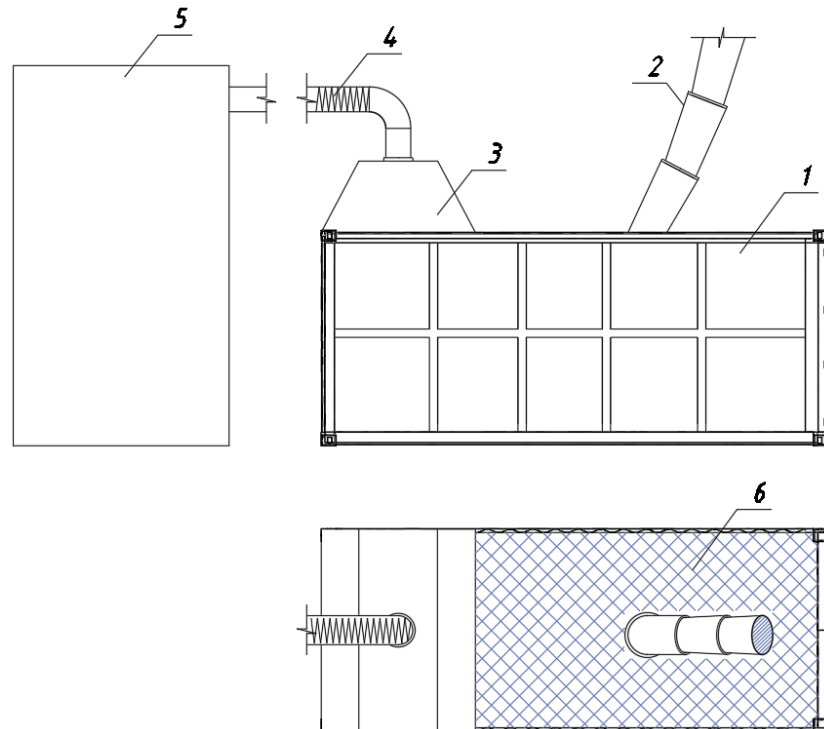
Укрытие и система обеспыливания перегрузки отходов ремонтно-строительного процесса: 1 — контейнер; 2 — рукав для сброса отходов; 3 — аспирационное устройство (конфузор); 4 — гофрированный воздуховод; 5 — мобильная установка для очистки пылевоздушной смеси; 6 — укрытие контейнера (тент)
